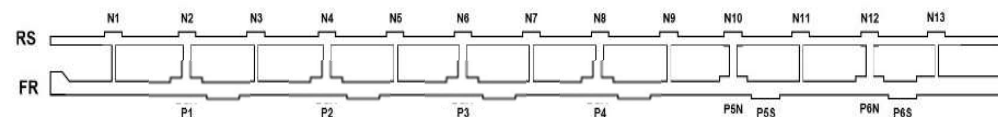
Tunnellayout, modifiziert – Variante 6
